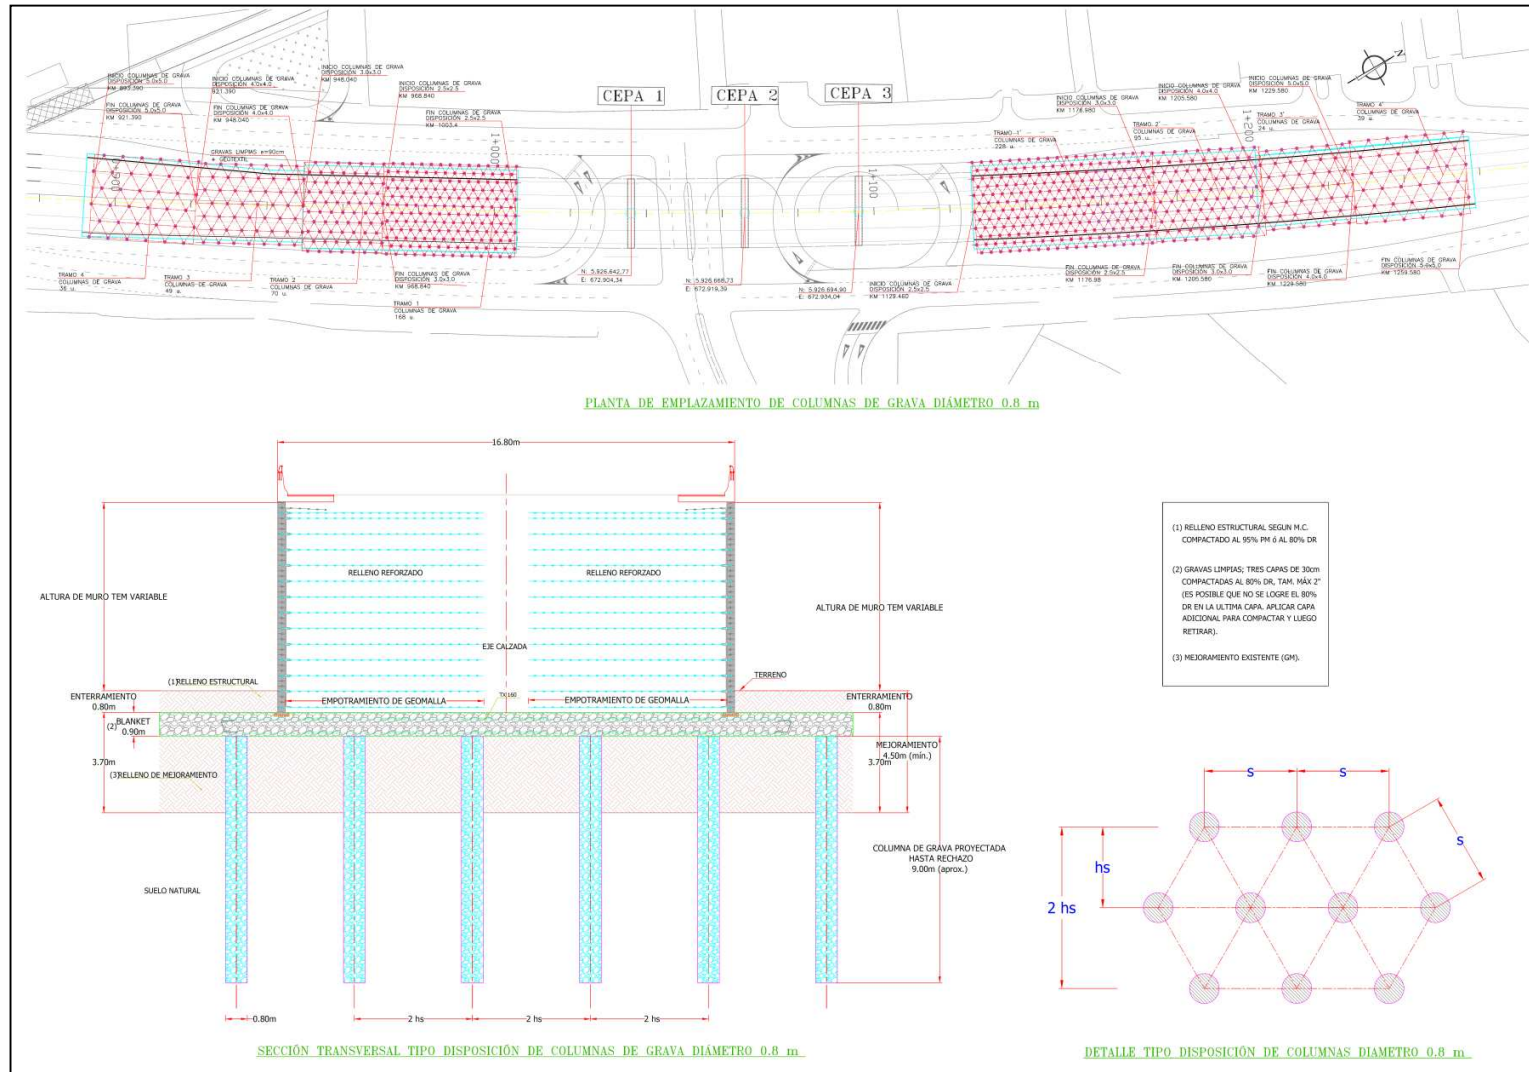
Plano de disposición en planta, sección y detalle tipo de columnas de grava en Viaducto Jorge Alessandri.
